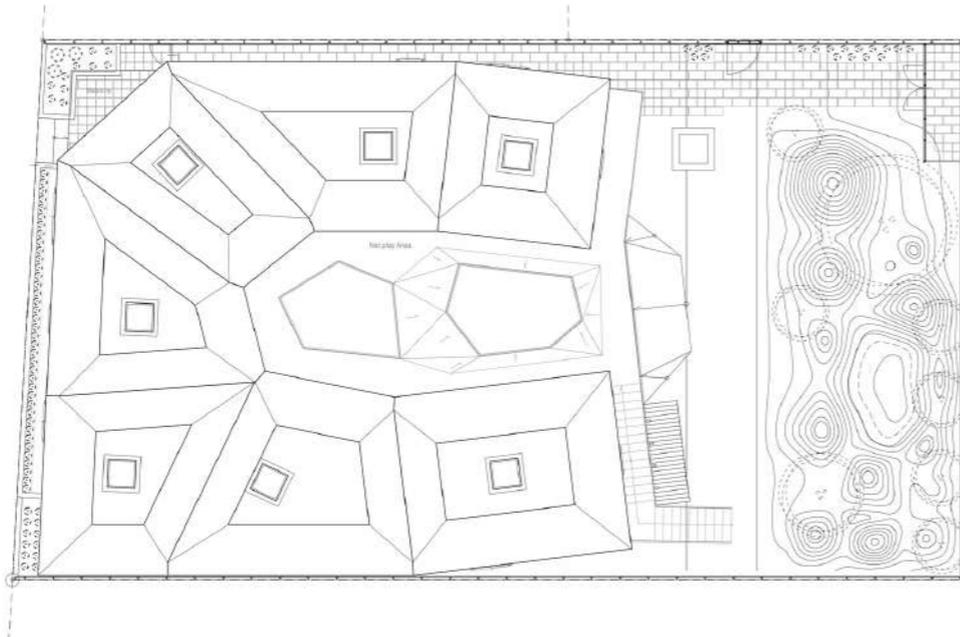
plano escuela planta cubierta. Fuente: <https://architects.team-lab.com/projects/kidslabo-nagareyama/>
